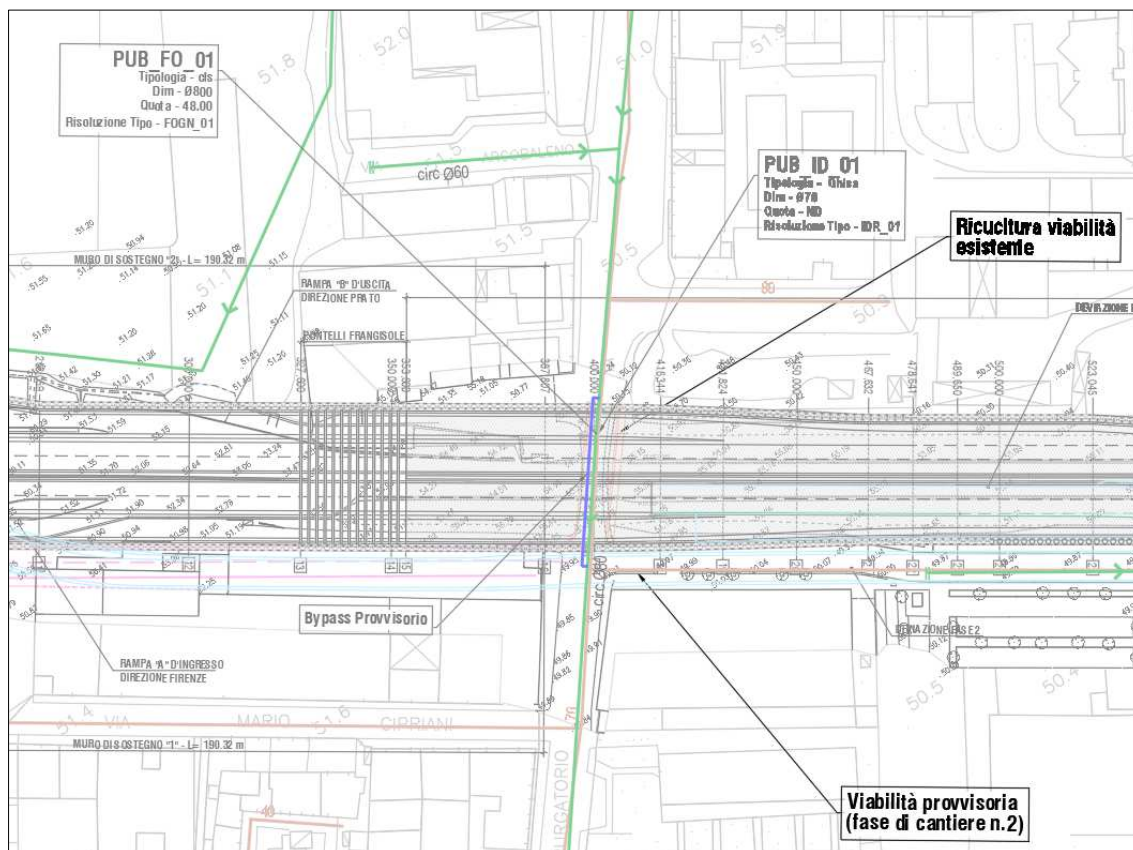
Risoluzione interferenza Via Roma - Planimetria
